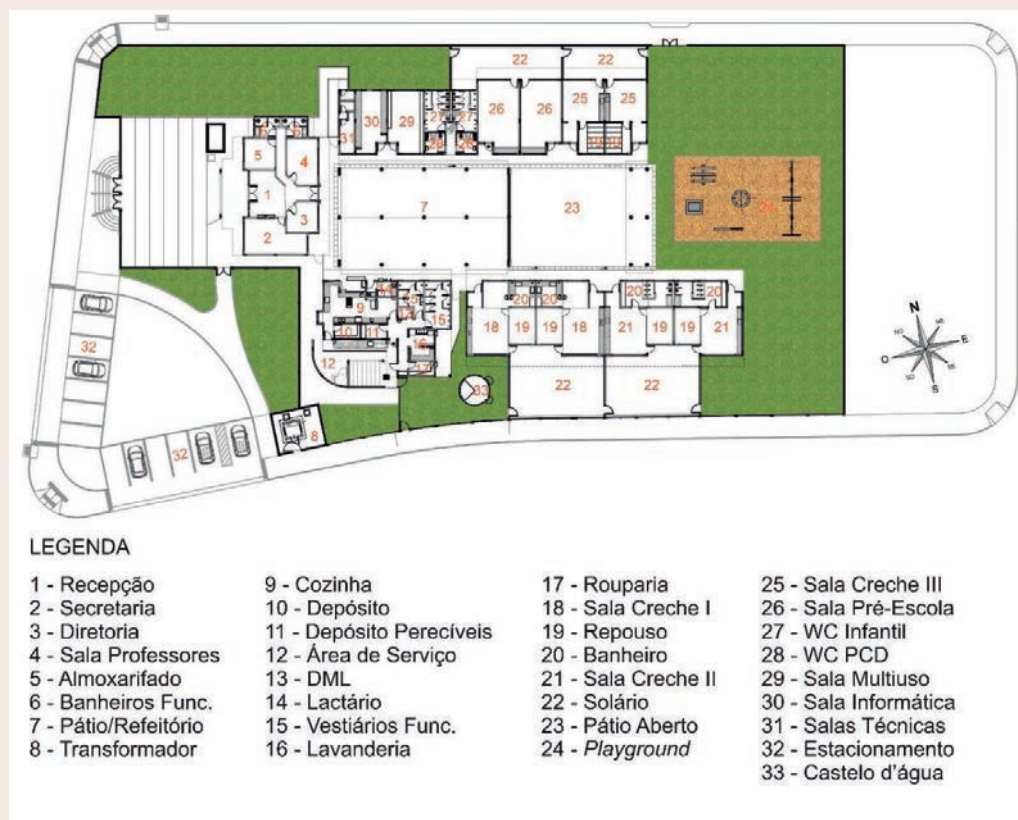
Planta Baixa Projeto Proinfância Tipo B, adaptado de FNDE (2013).
